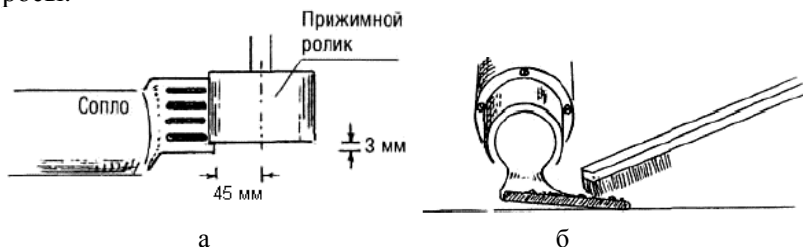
Регулировка сварочного автомата сварки
